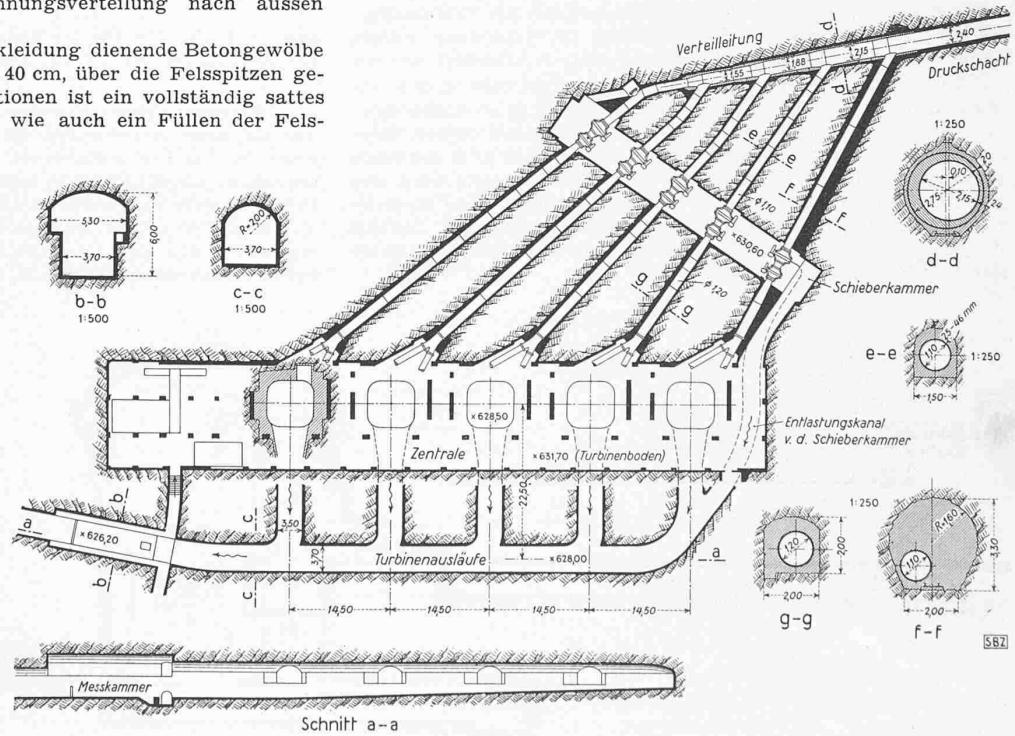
Verteilleitung, Zentrale und Turbinenausläufe; Grundriss 1:1000 und Schnitte
